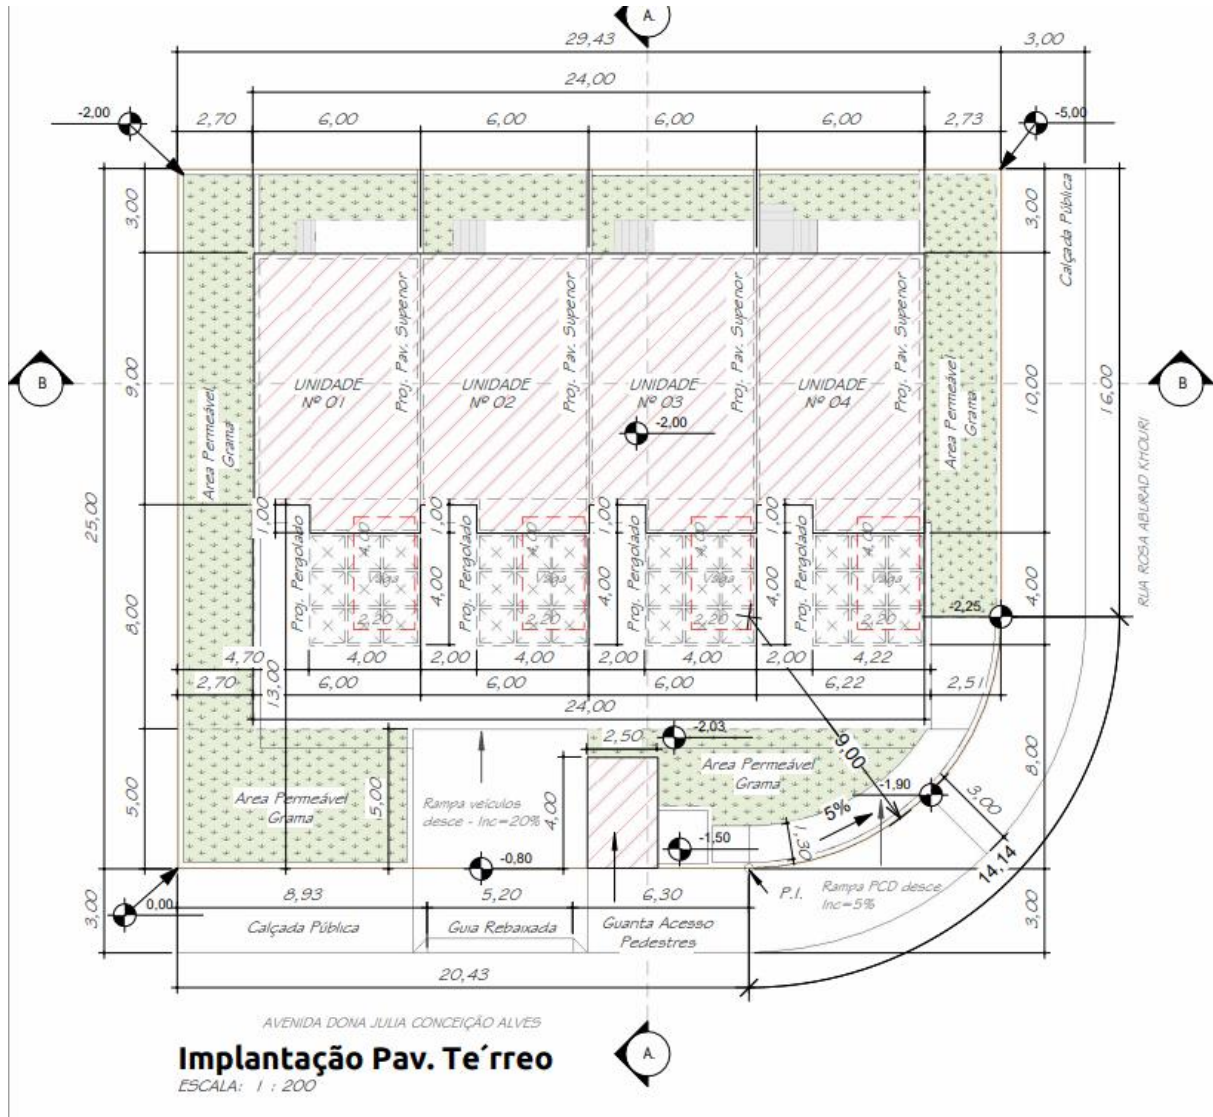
Projeto Simplificado – Pavimento Té'rreo
